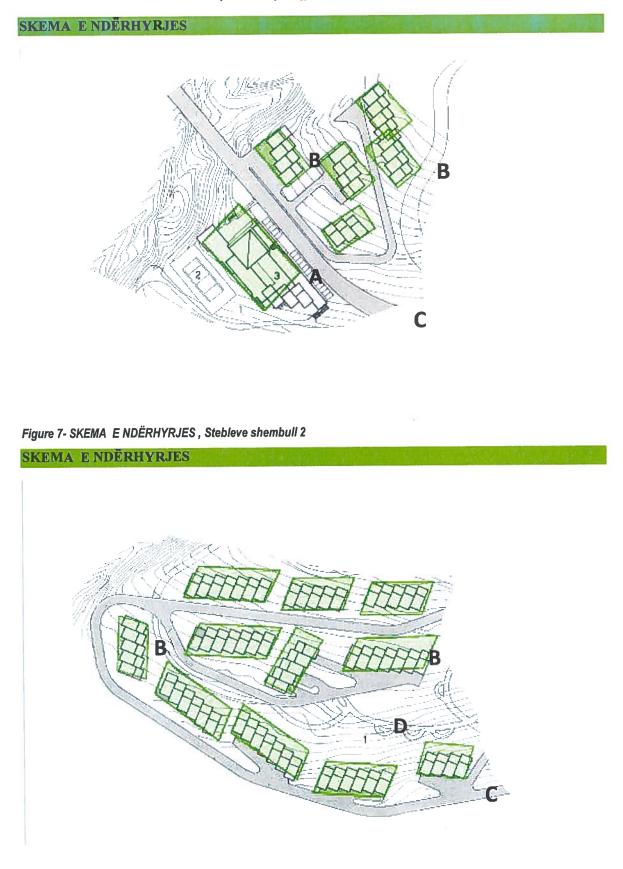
Skema e ndërhyrjes : plan , Stebleve shembull 2
